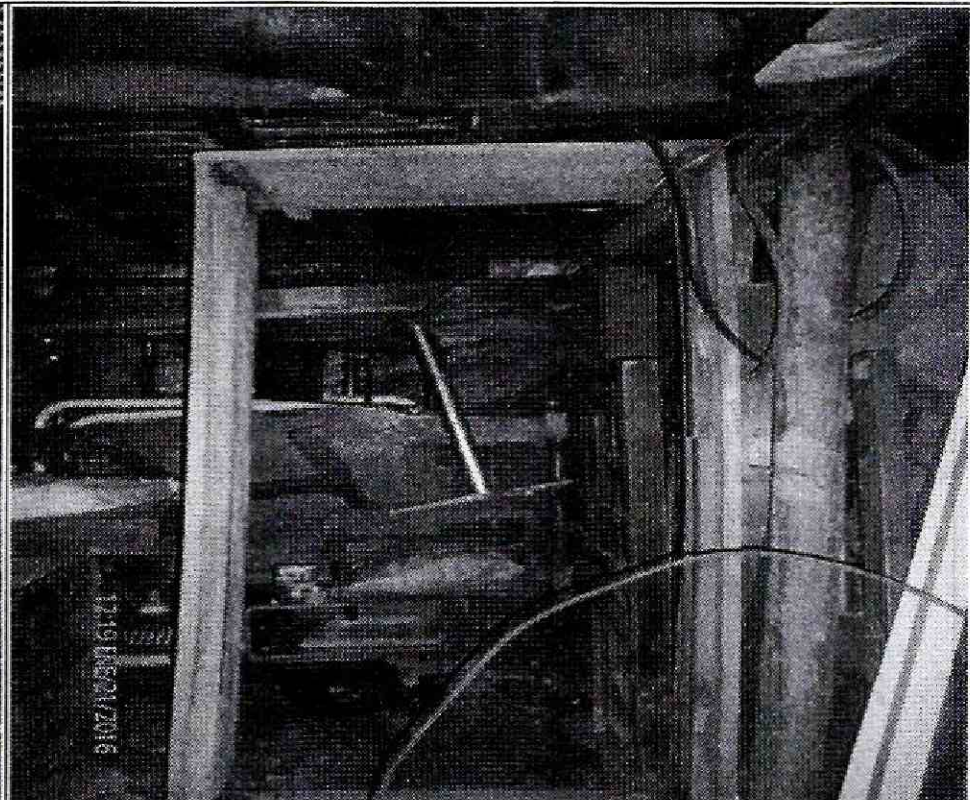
Vista del sector donde se emplaza la vivienda emplazada en el predio de la Calle 25 Sur No 16-07 Este.
